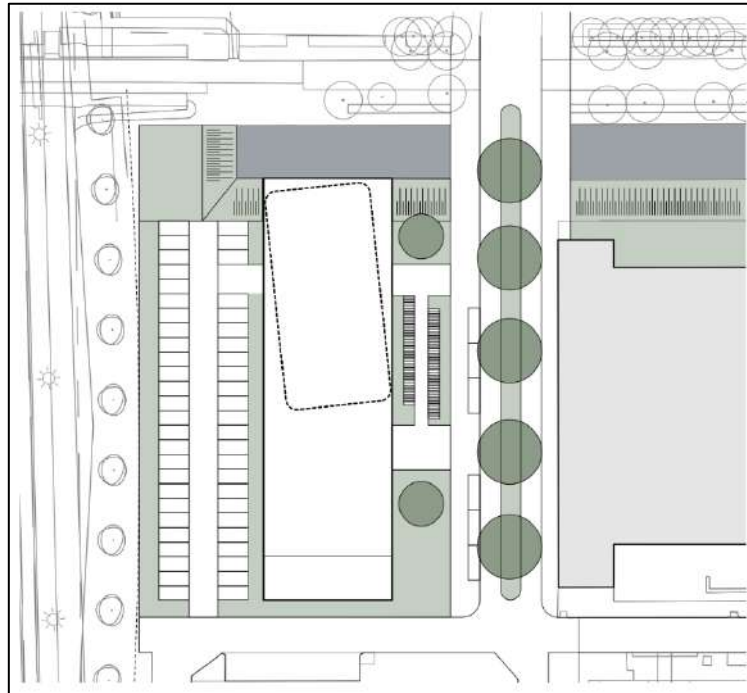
, Maaiveldinrichting van voorgenomen plan (bron: inbo)
